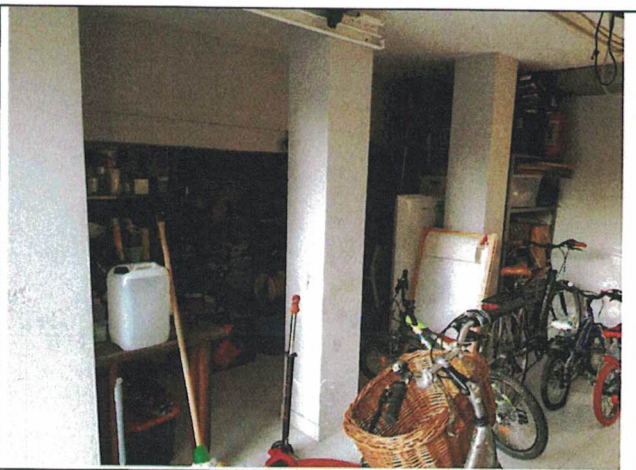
Aumento di superficie con occupazione della porzione di terrapieno a sinistra
